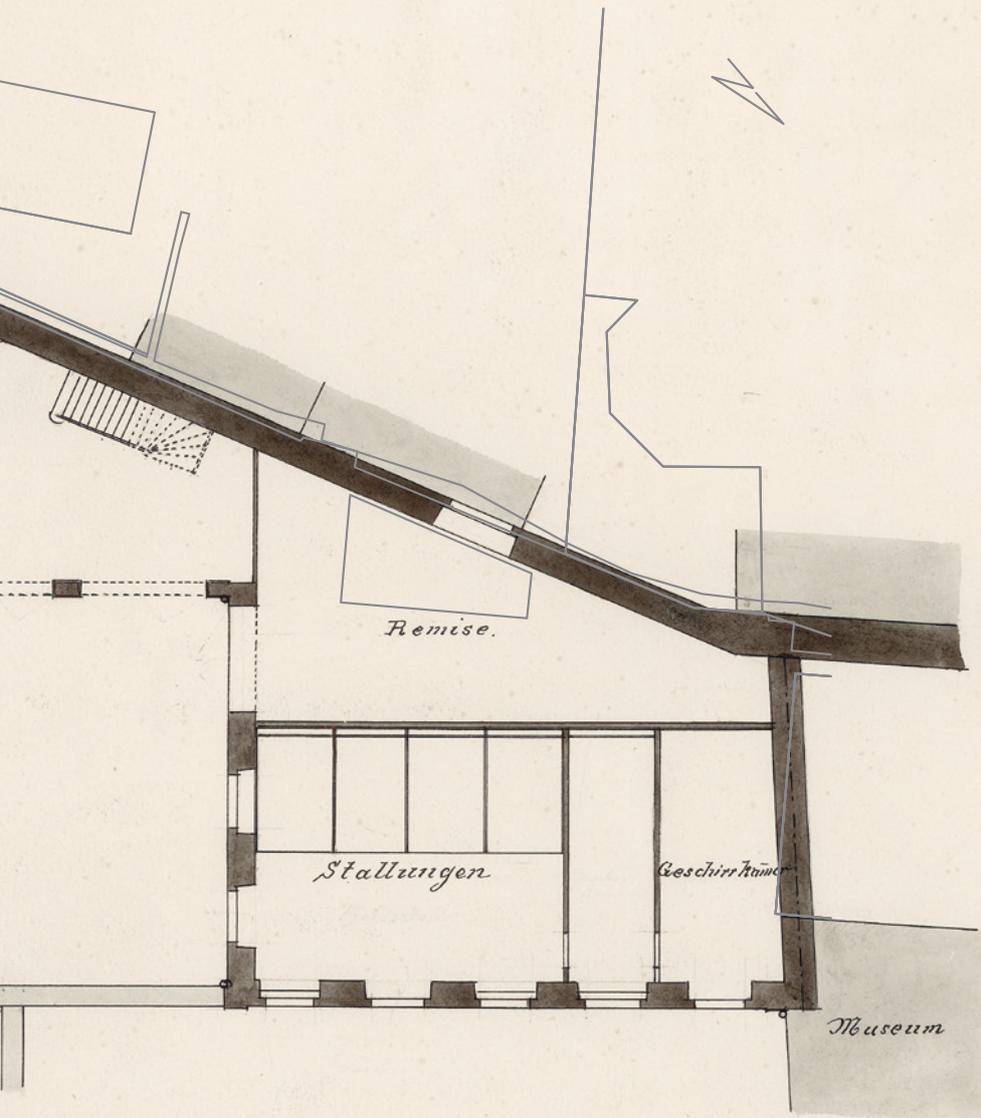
Plan des Fabrikgebäude-Erdgeschosses mit Bezeichnung der Räume, aufgenommen vor 1913, hier verkleinert abgebildet.
